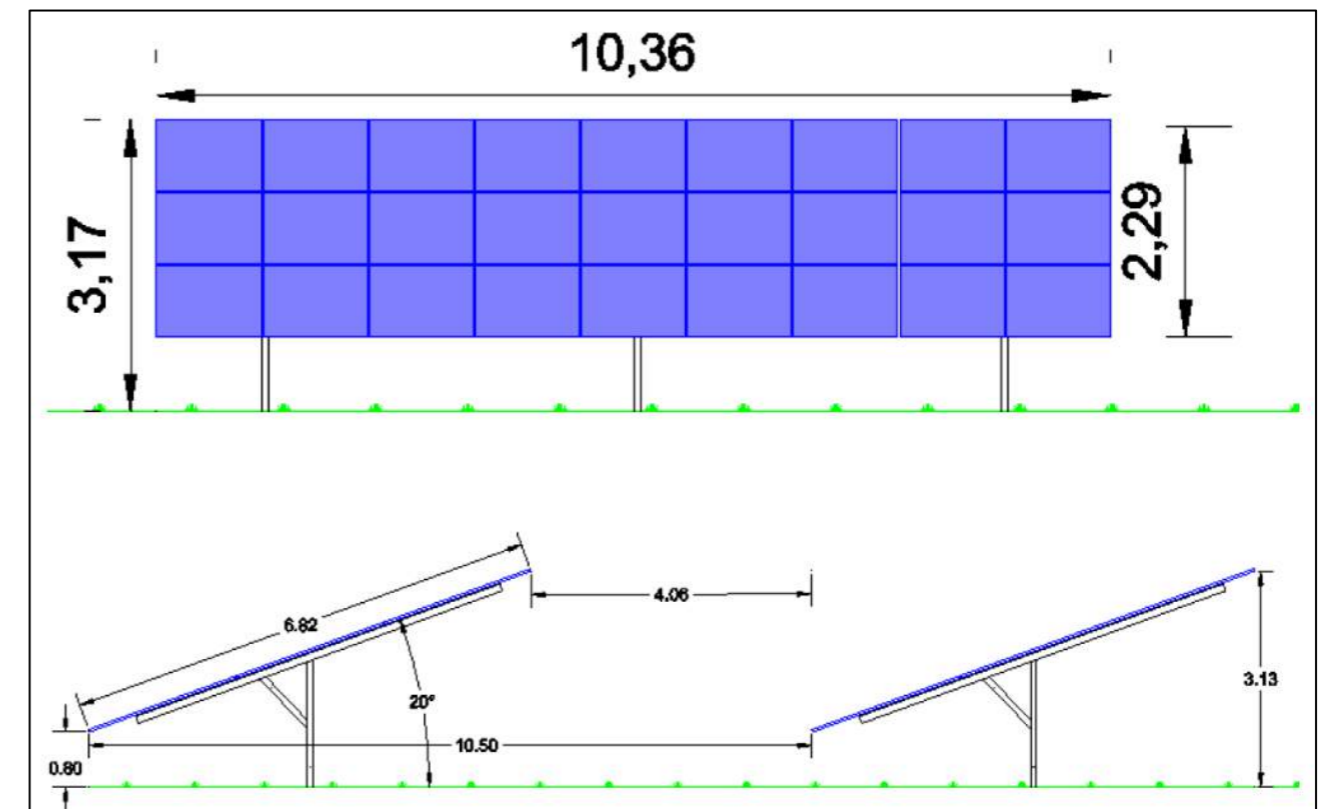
Vue de face et coupes des structures 3V9 inclinées à 20°
